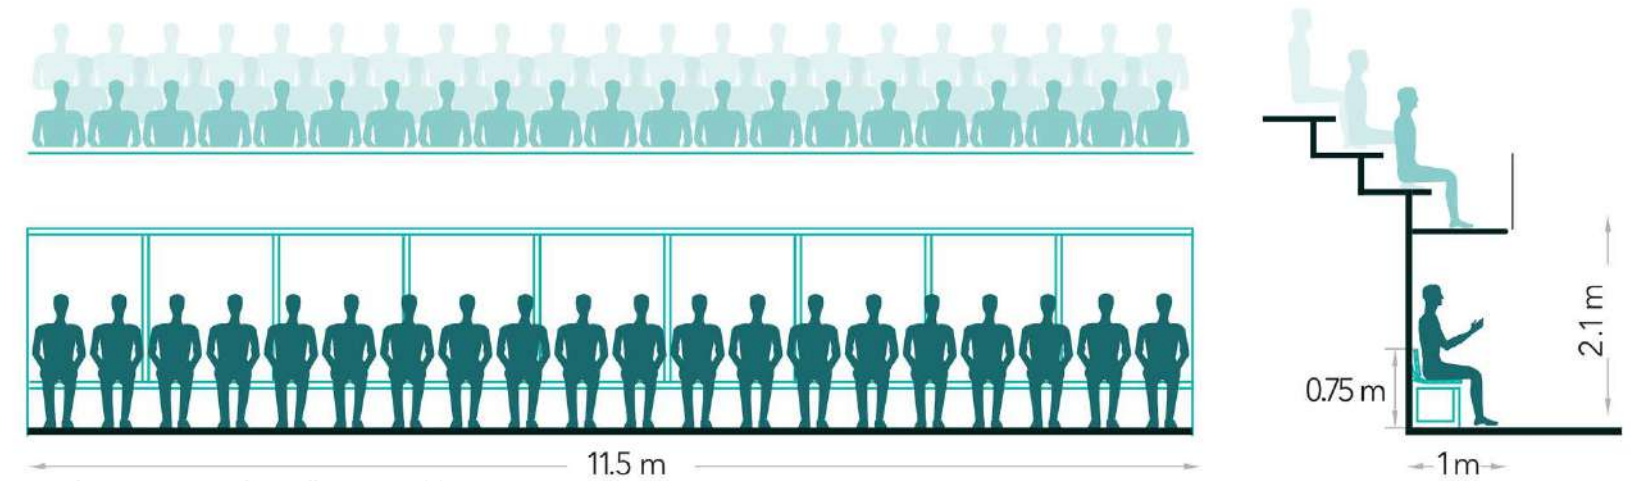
Elevación y sección banquillos Fuente: Elaboración propia
